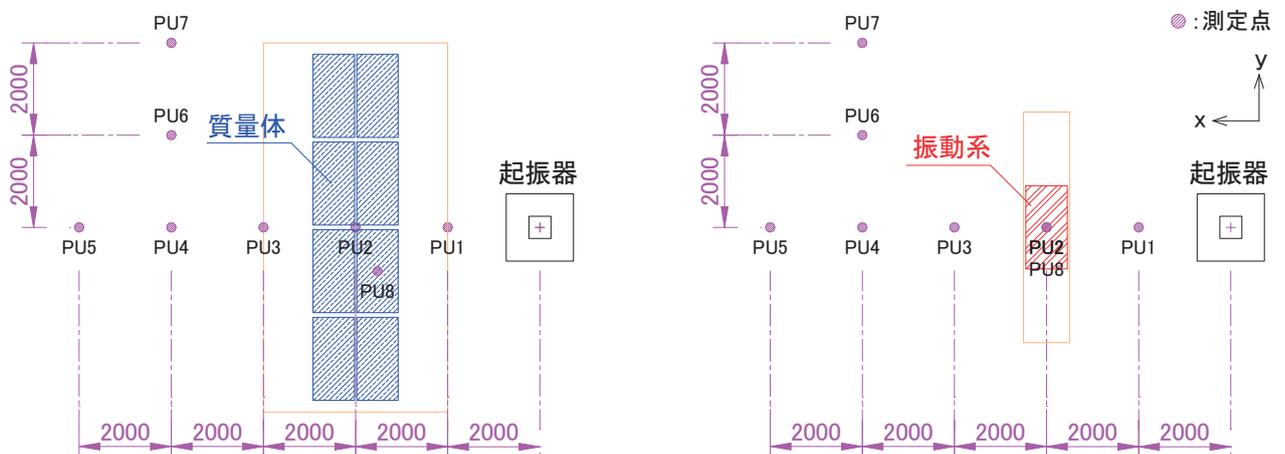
実験配置平面図 (左：質量体2列，右：振動系1基)
